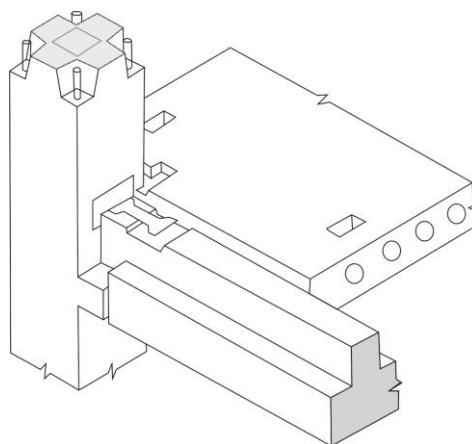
Схема примыкания колонны, ригеля и ж.-б. перекрытия
